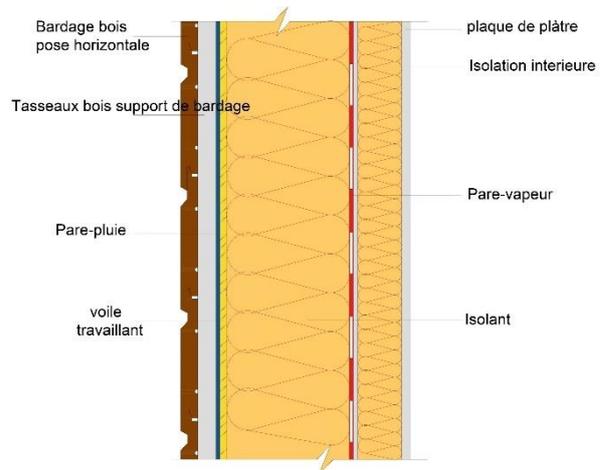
Les couches d'un mur en panneau sandwich, source : auteur.
